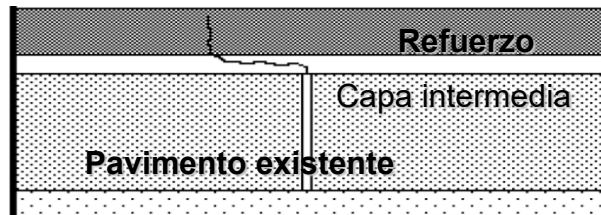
Redireccionado de la fisura y atraso de la reflexión. (Delbono, 2014)
